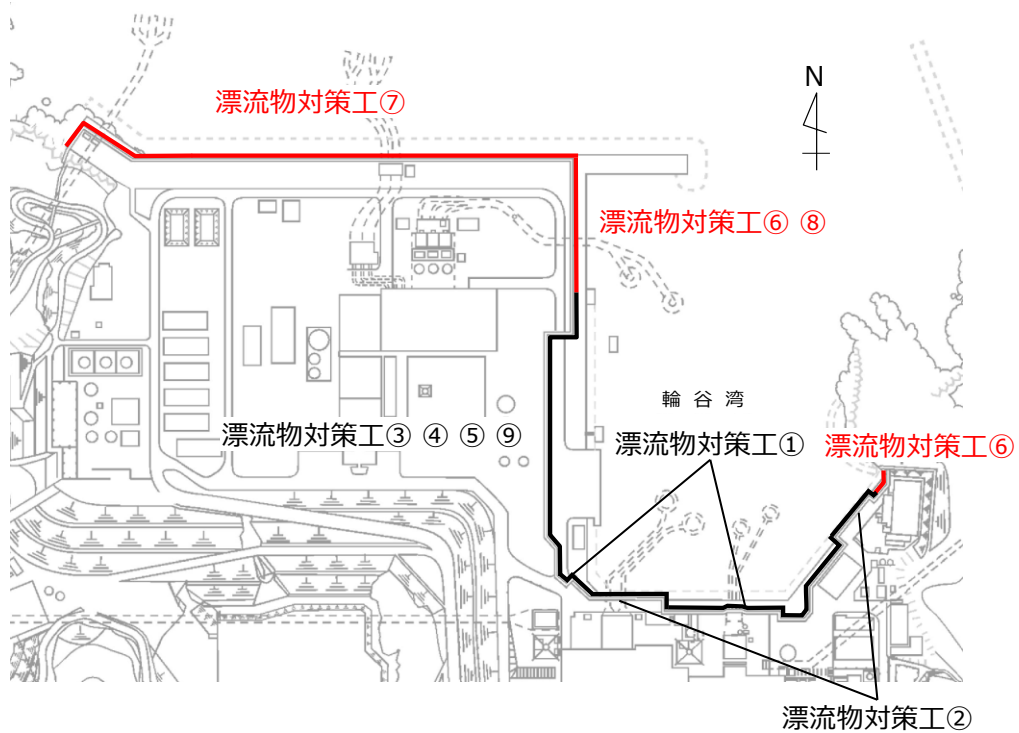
漂流物対策工（鉄筋コンクリート版）の構造区分図
